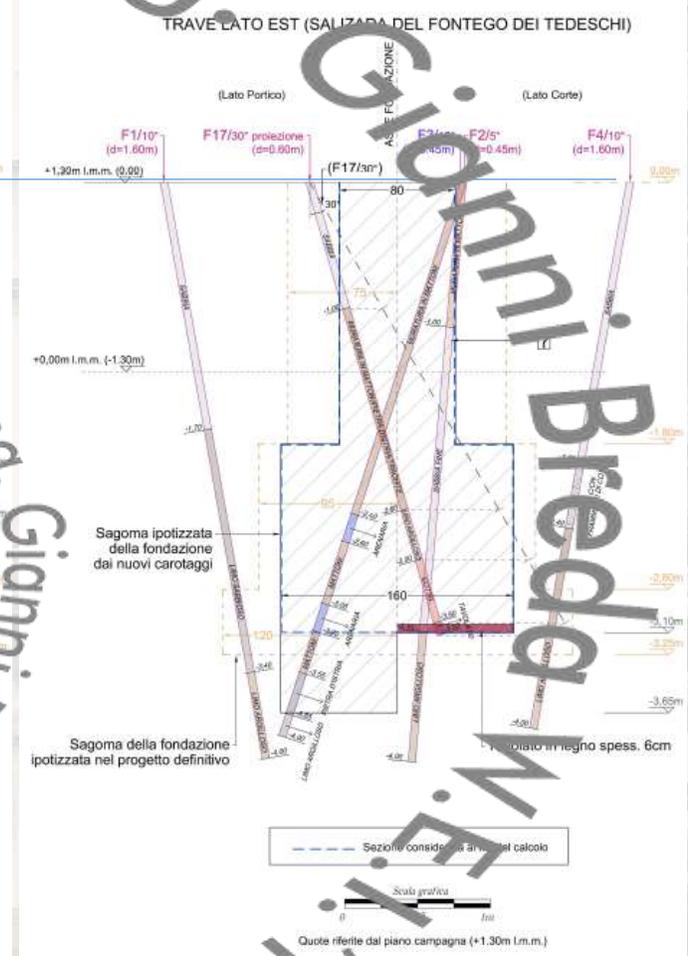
sezione tipo e carotaggi fondazione muro lato Est
